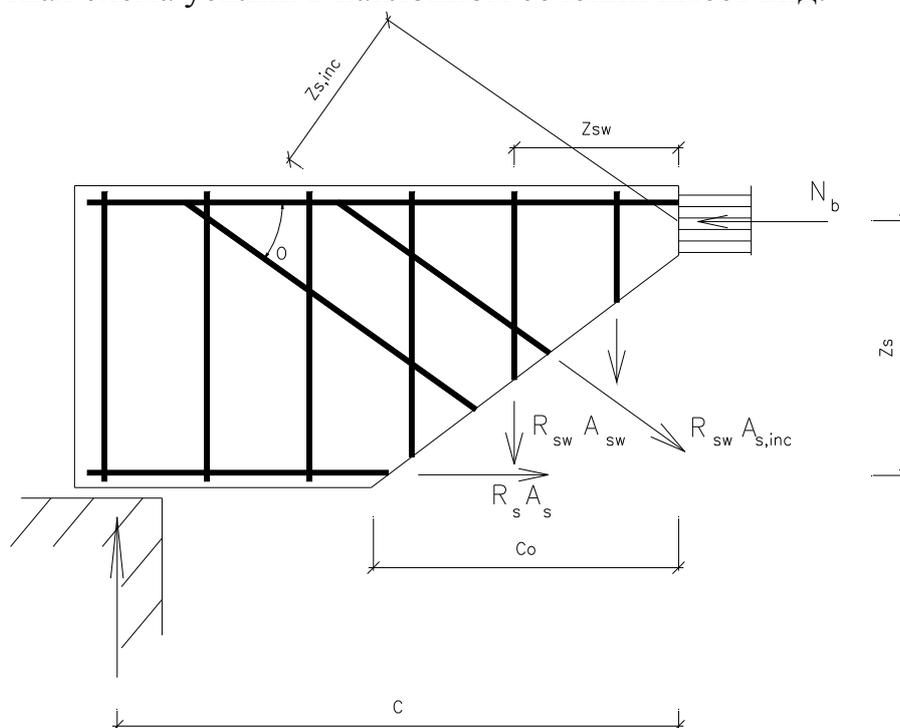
Расчетная схема усилий в наклонном сечении при расчете прочности по поперечной силе
